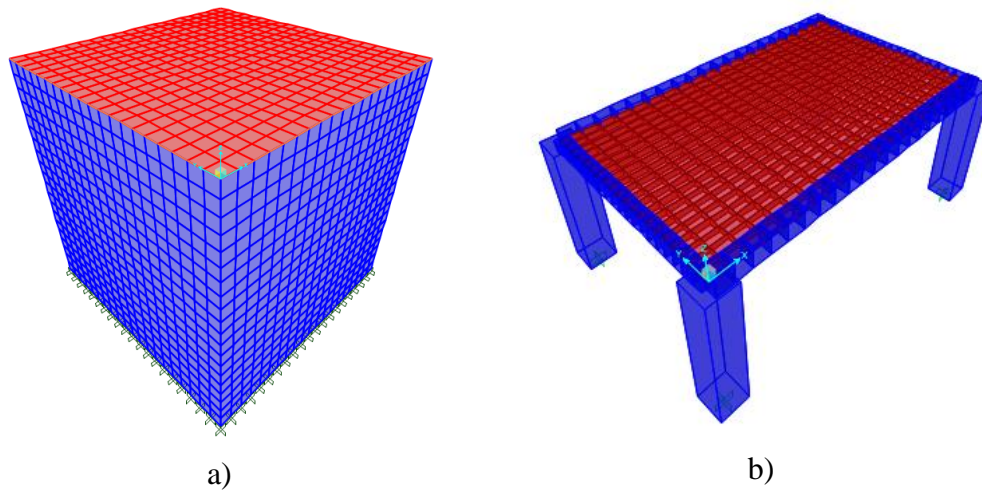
Modelo de losa con apoyo: a) rígido y b) flexible.
